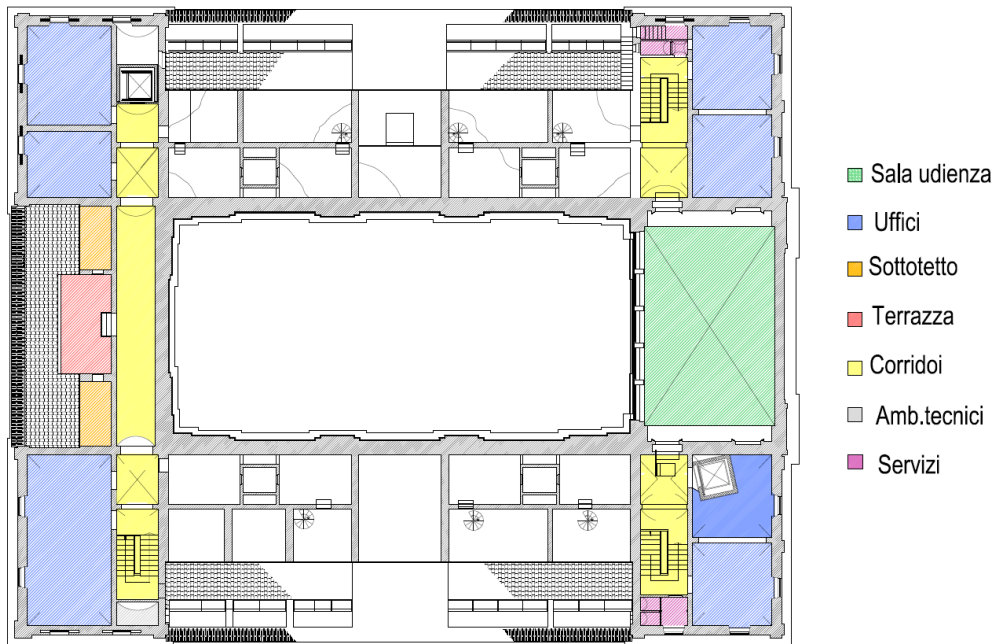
Planimetria del piano primo con indicazione degli ambienti a quota 6 m
